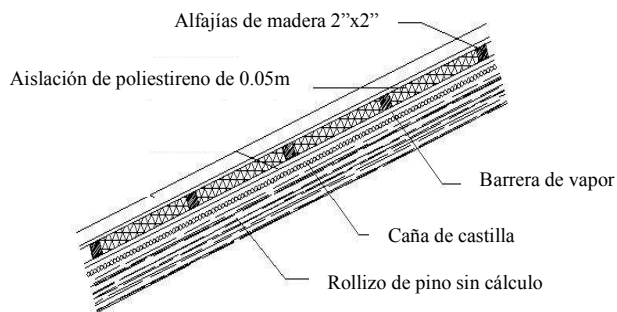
Detalle constructivo de la cubierta de la vivienda.
